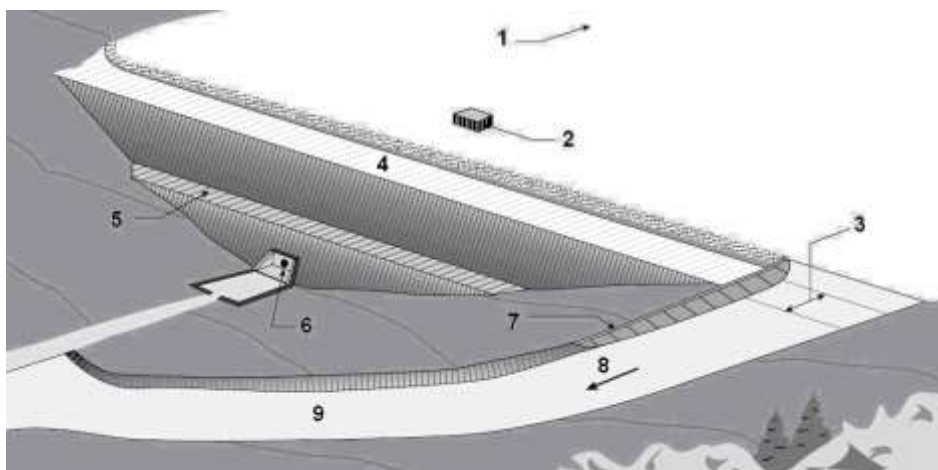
Схематичный вид со стороны нижнего бьефа низконапорного гидроузла с грунтовой плотиной, открытым береговым водосбросом и водоспуском: 1 – водохранилище; 2 – входной оголовок закрытого водоспуска/водосброса с сороудерживающей решеткой; 3 – нерегулируемый водосливной порог берегового водосброса; 4 – гребень грунтовой плотины; 5 – берма дренажного банкета; 6 – выходной оголовок донного водоспуска; 7 – берма направляющей дамбы; 8 – направление течения; 9 – отводящий канал
